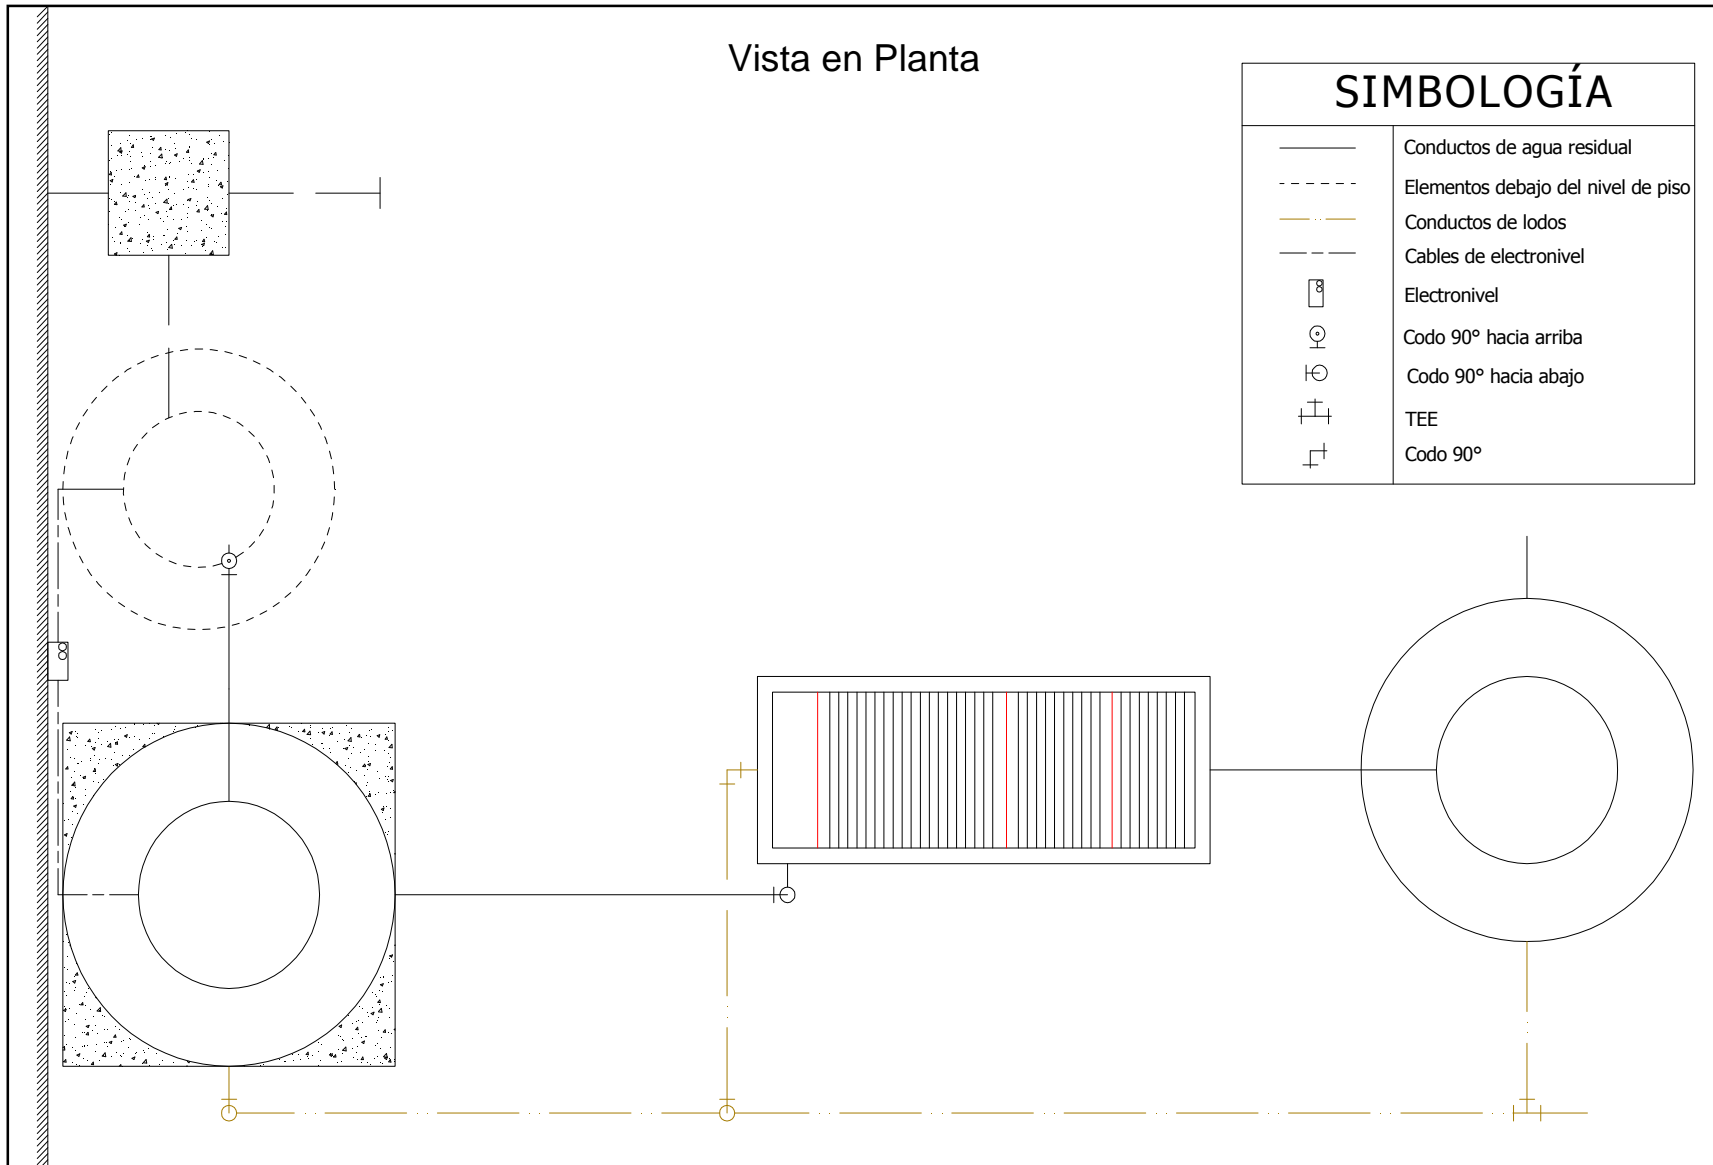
Vista en planta del sistema de tratamiento a base de CBR
